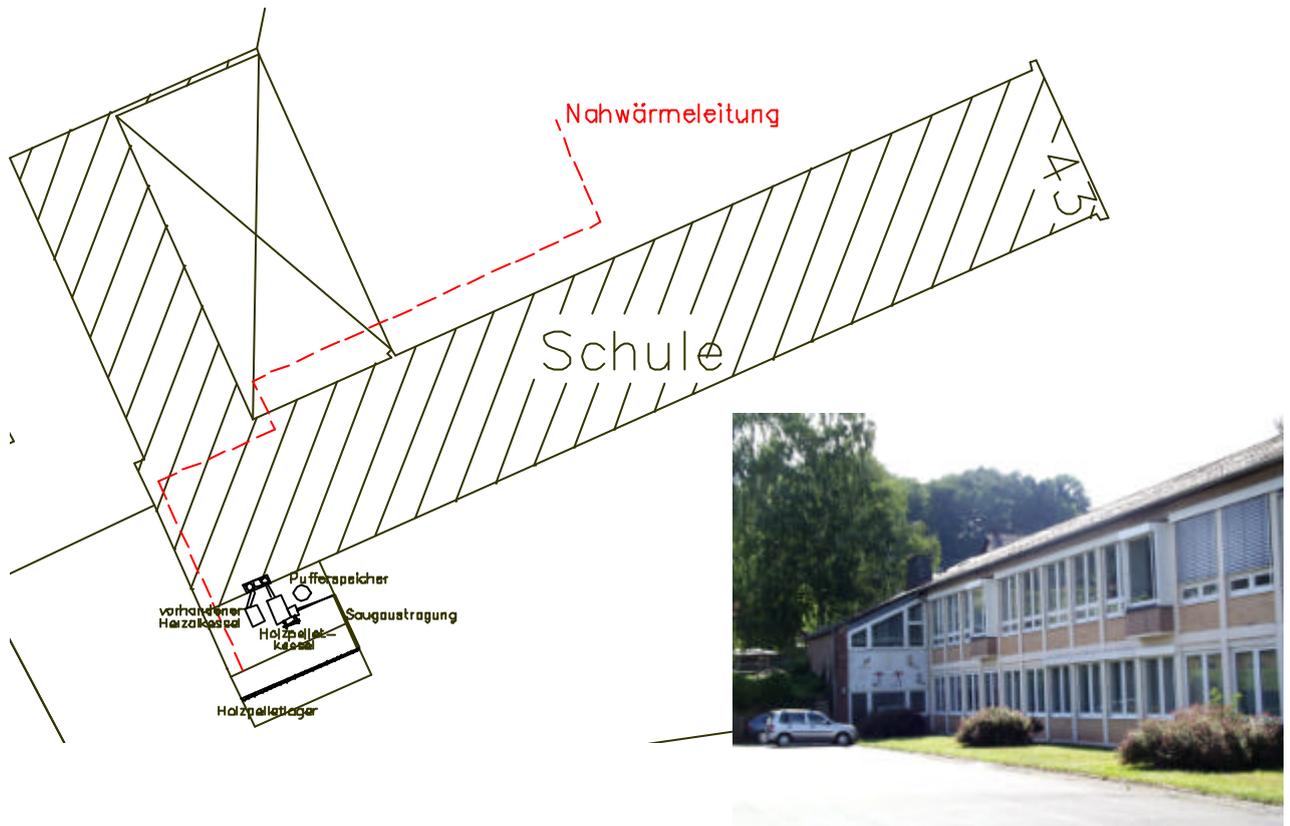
Lageplan mit Heiz- und Lagerraum (nicht maßstäblich)
